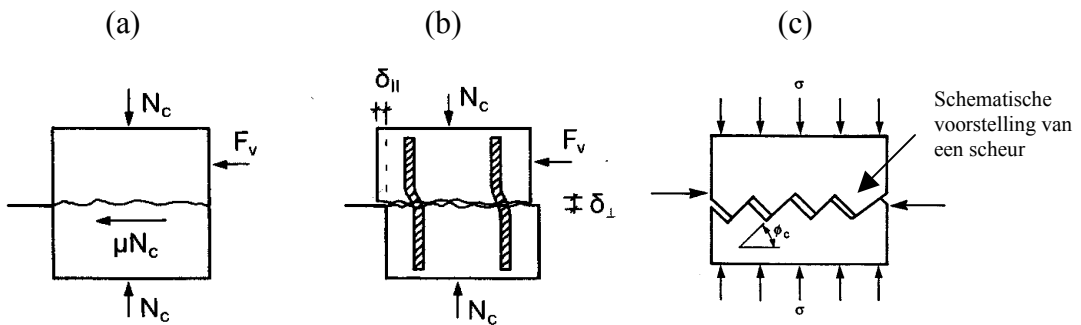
Overdracht van schuifspanningen door wrijving
